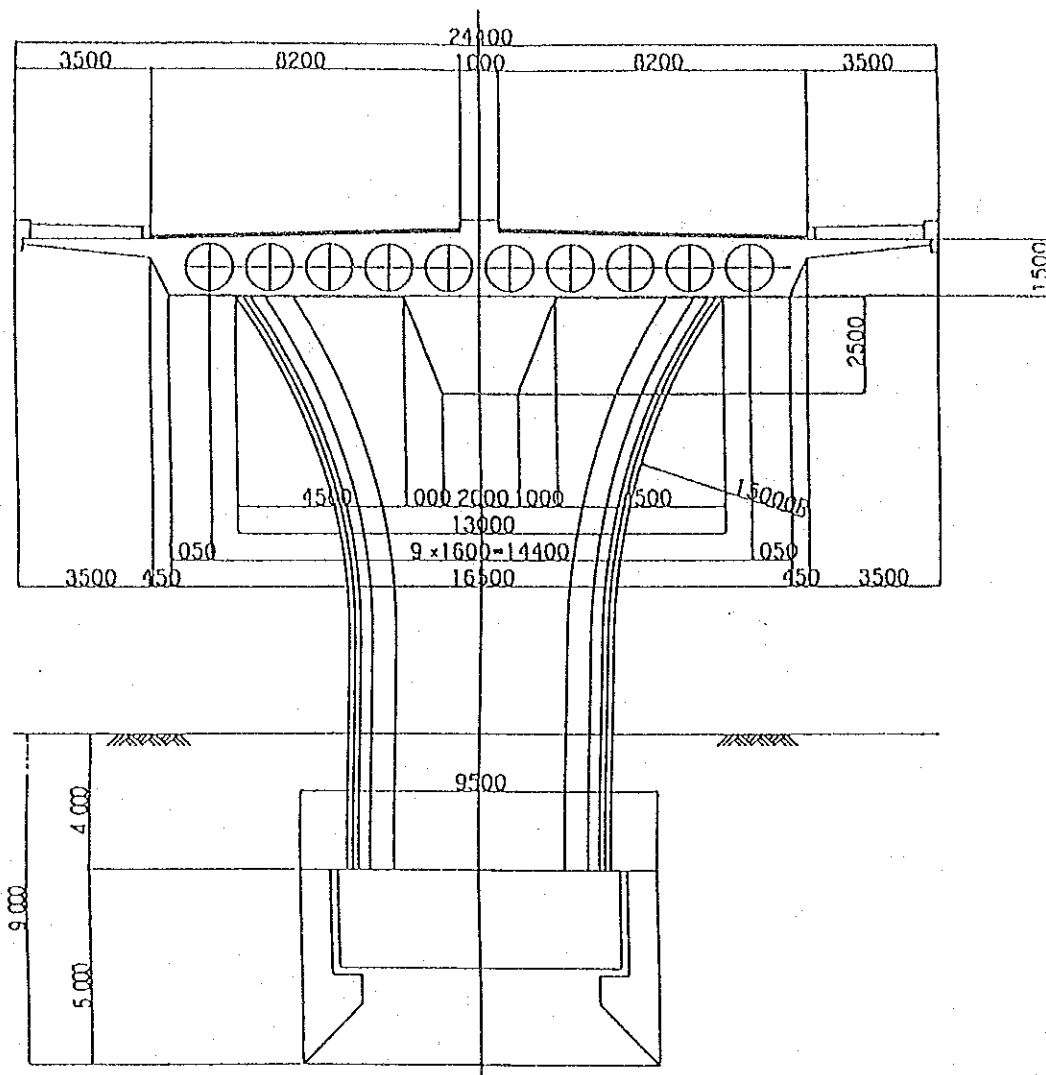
Sección Transversal del Nuevo Puente Biobío
